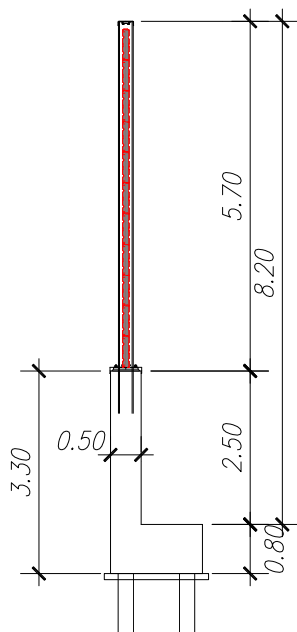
Sezione tipo barriera antirumore ML7 su rilevato
